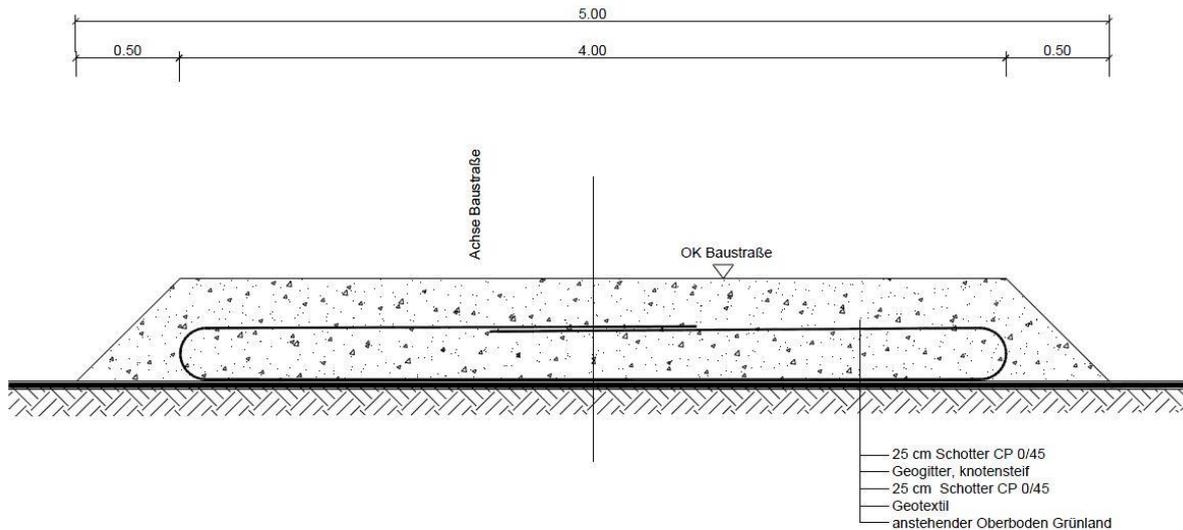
Aufbau der Baustraße auf nicht tragfähigem Grund
